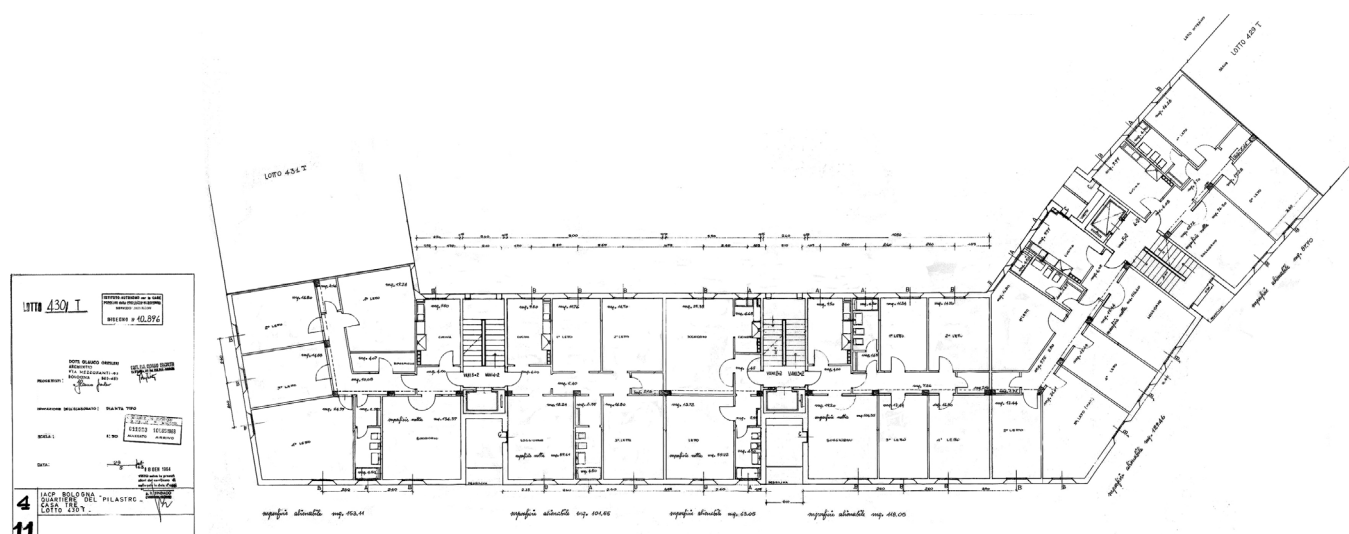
Pianta tipo dell'edificio di Glauco Gresleri al Pilastro, 1966. Archivio Storico ACER Bologna.
